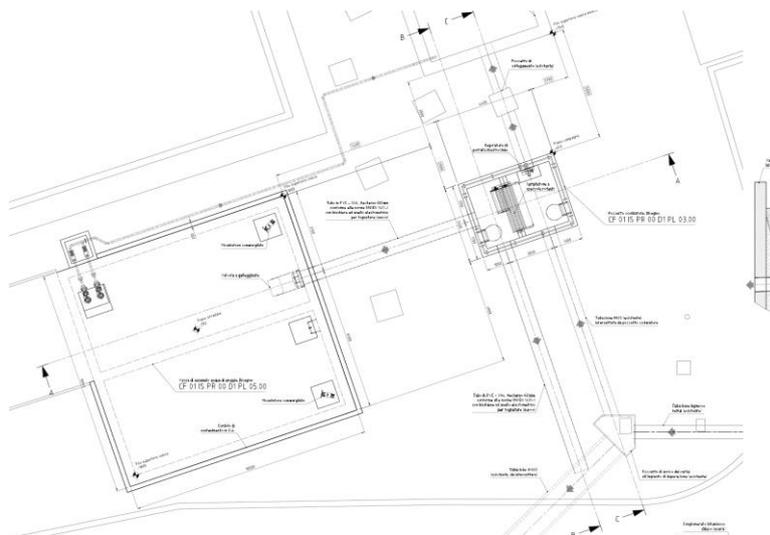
stralcio planimetrico dell'impianto di prima pioggia
